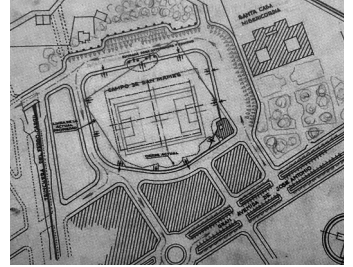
Plano de una posible corrección en planta de los ejes del estadio para alinearlos en la medida de lo posible con las directrices del Plan de Ensanche.
